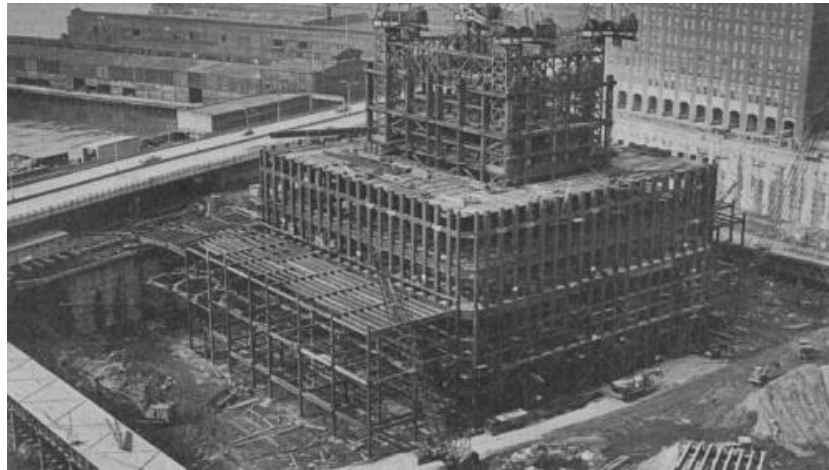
Foto de la cimentación de las Torres Gemelas, extraída de internet
